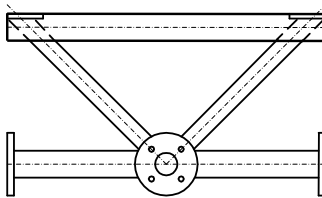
Окремий елемент (фрагмент) збірних структурних сталезалізобетонних конструкцій
